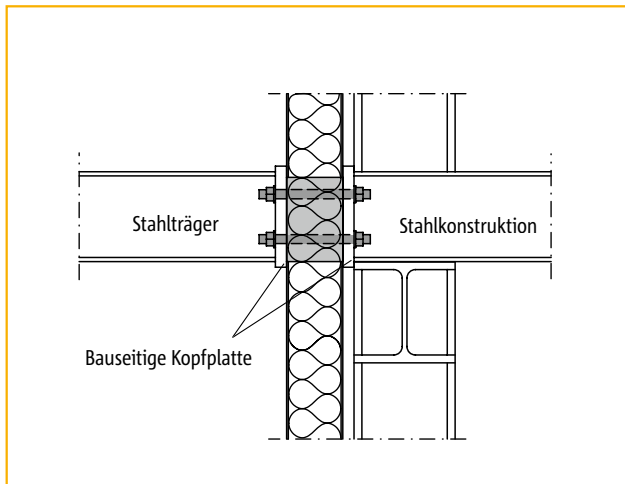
Schöck Isokorb® Typ KST für frei ausragende Stahlkonstruktionen
